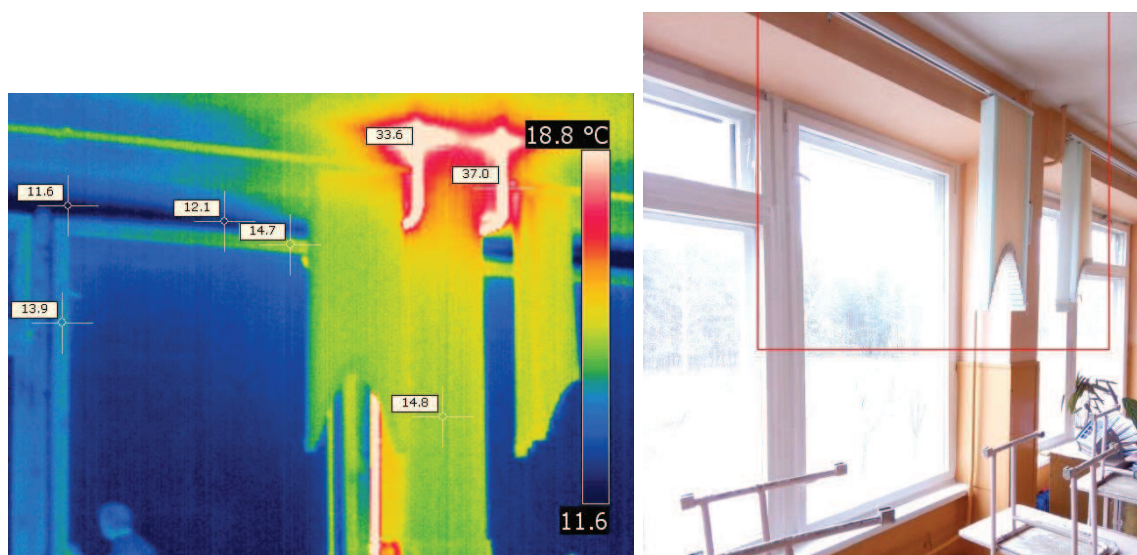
Стена помещения №214 (учебный класс), северный фасад
